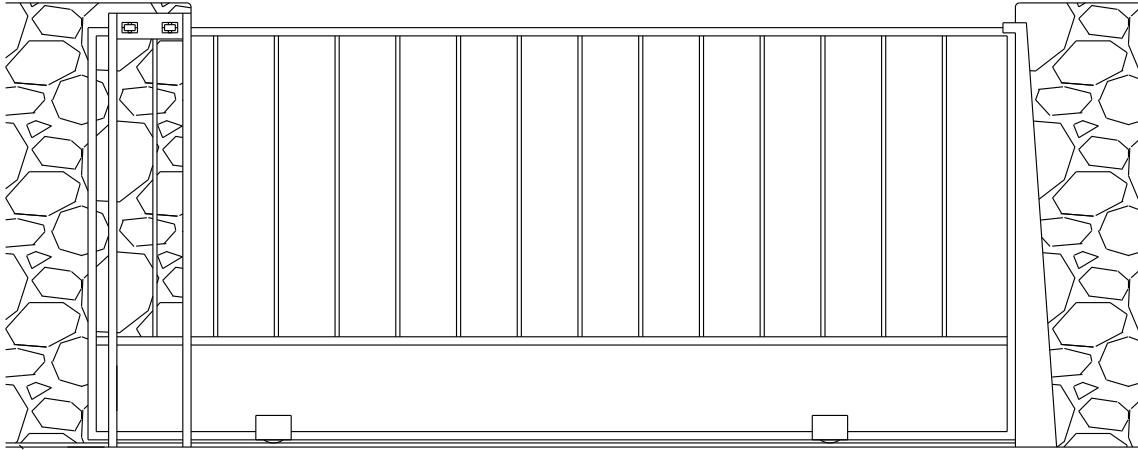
Detalle de alzado de puerta industrial corredera cancela.
